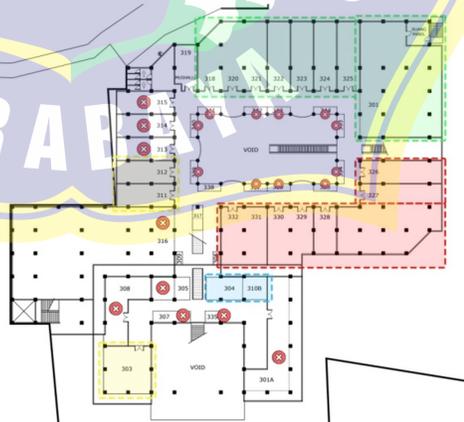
8 Denah Lantai 1(Sesudah Redesain)
